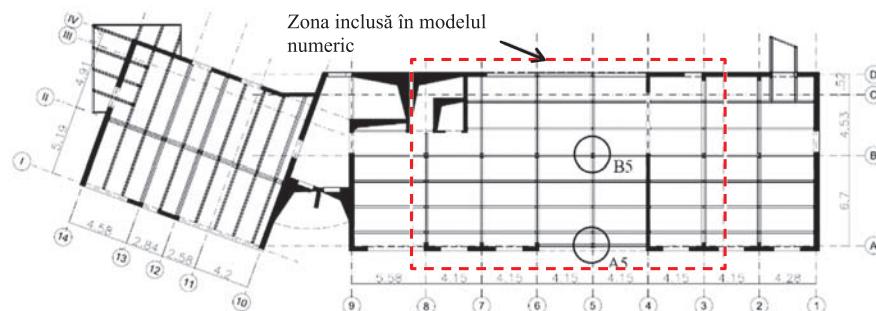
Vedere plană cu pozițiile stâlpilor înălțurați, A5 și B5
